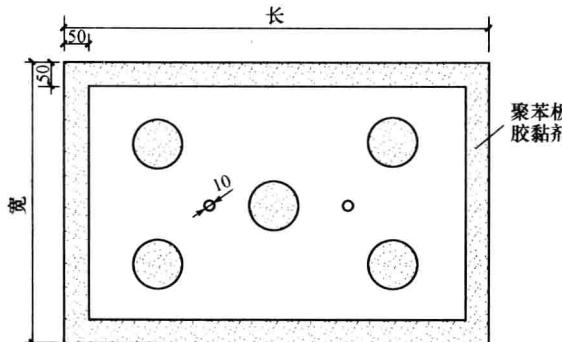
封闭框点粘聚苯板示意图 (单位: mm)
